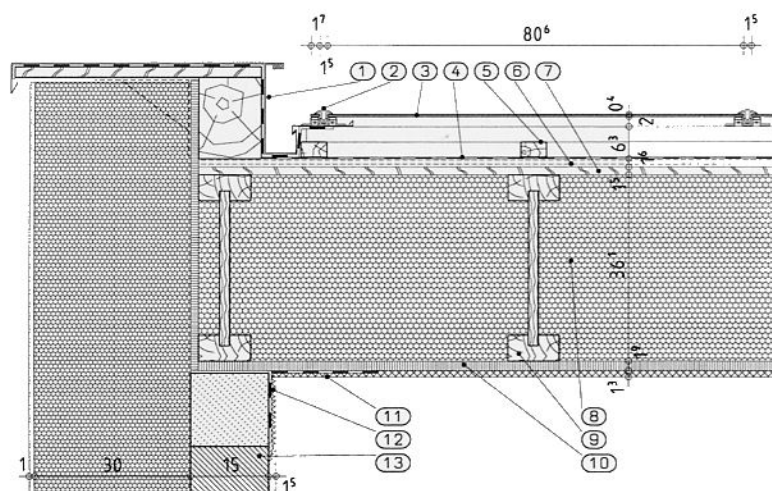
Débord de toit d'un toit solaire - coupe de l'acrotère
